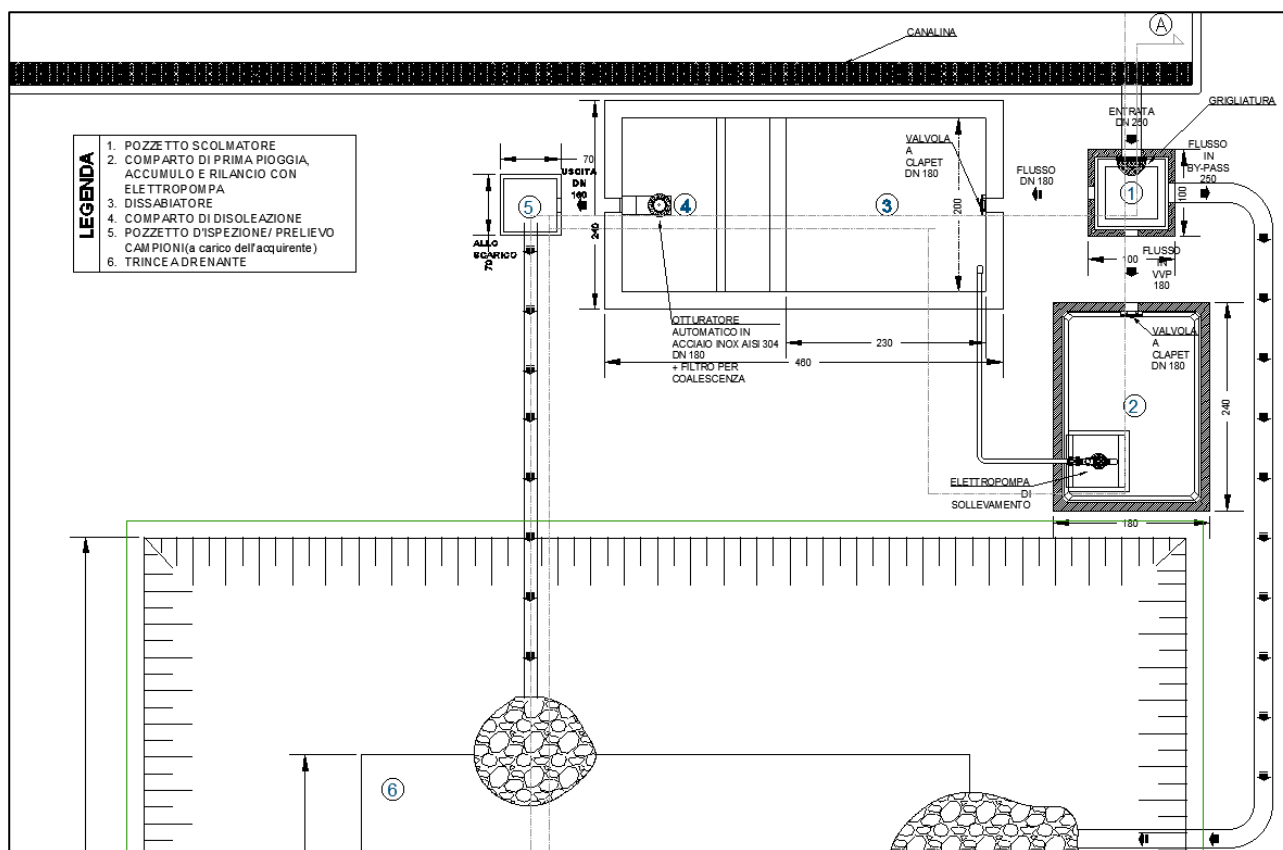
Stralcio planimetrico, sistema di trattamento delle acque meteoriche
